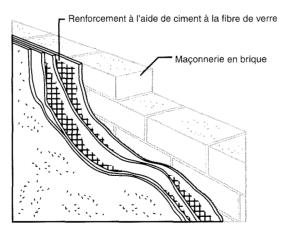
Renforcement des murs de maçonnerie à l'aide de ciment à la fibre de verre
